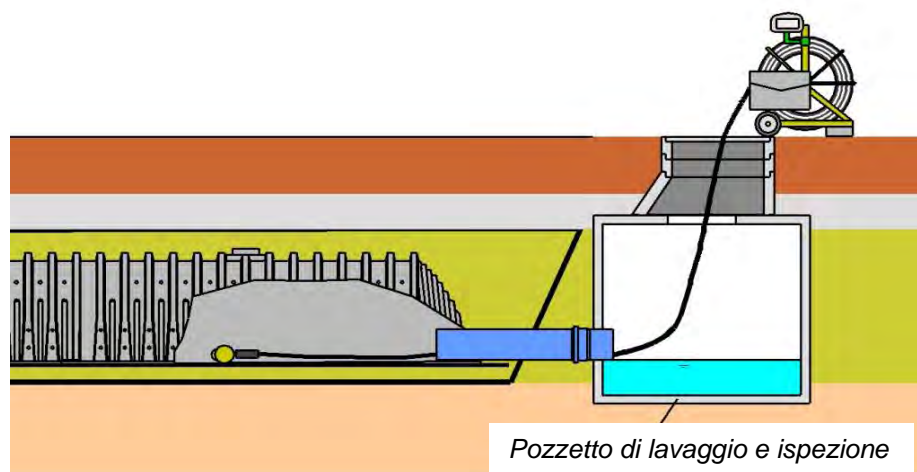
Ispezione con telecamera dall'ingresso del pozzetto di ispezione
